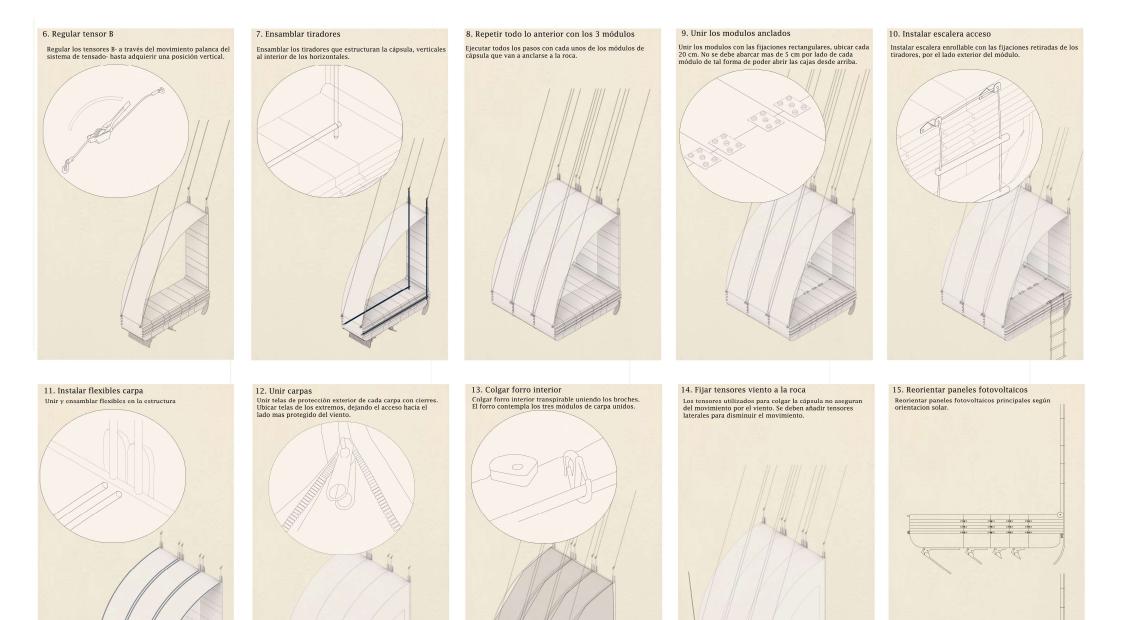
Instructivo de armado cápsula 2. Elaboración propia.
